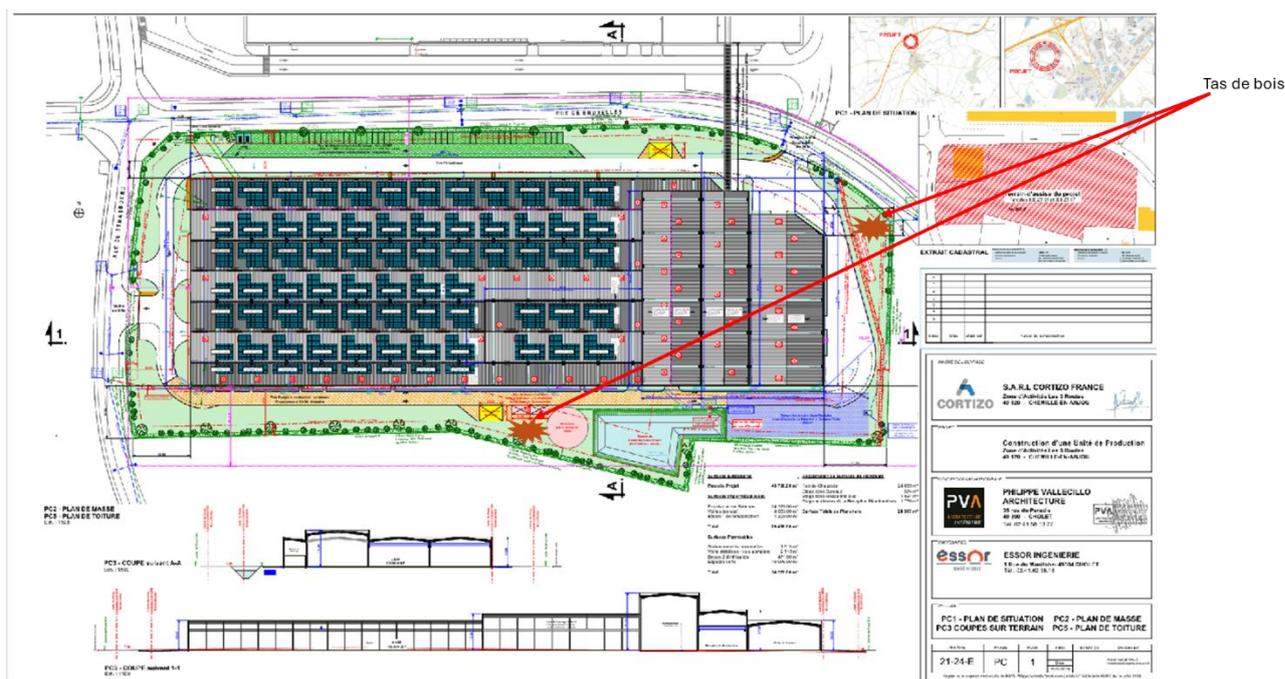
Localisation des tas de bois à entreposer sur le site de Cortizo (source : plan masse, janvier 2025)
